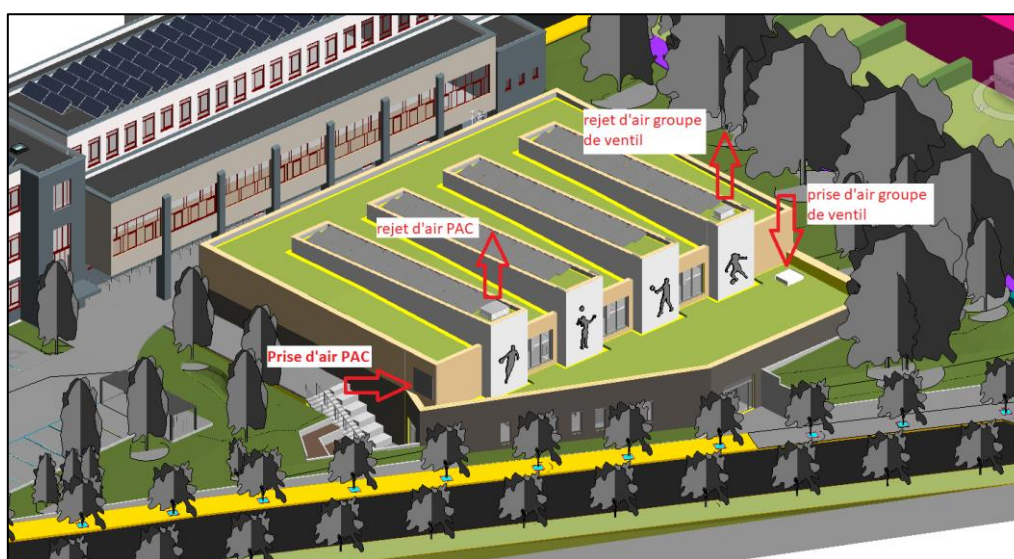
Localisation des prises et rejet d'air de la PAC et groupe de ventilation
